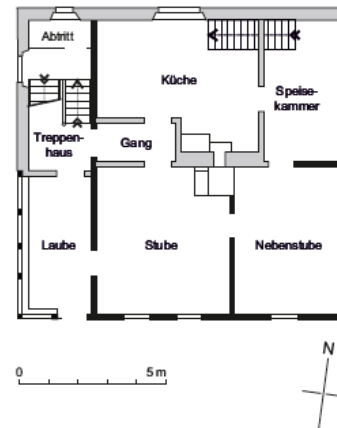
Grundriss Erdgeschoss, 1:200.
